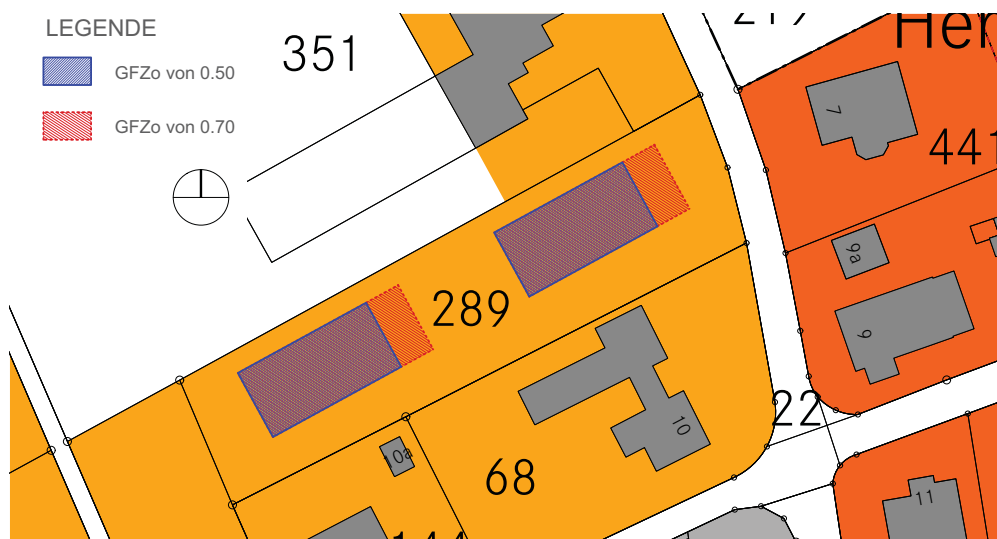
Einfluss der Geschossflächenziffer oberirdisch auf den "Fussabdruck" der Gebäude. Ohne Massstab.
